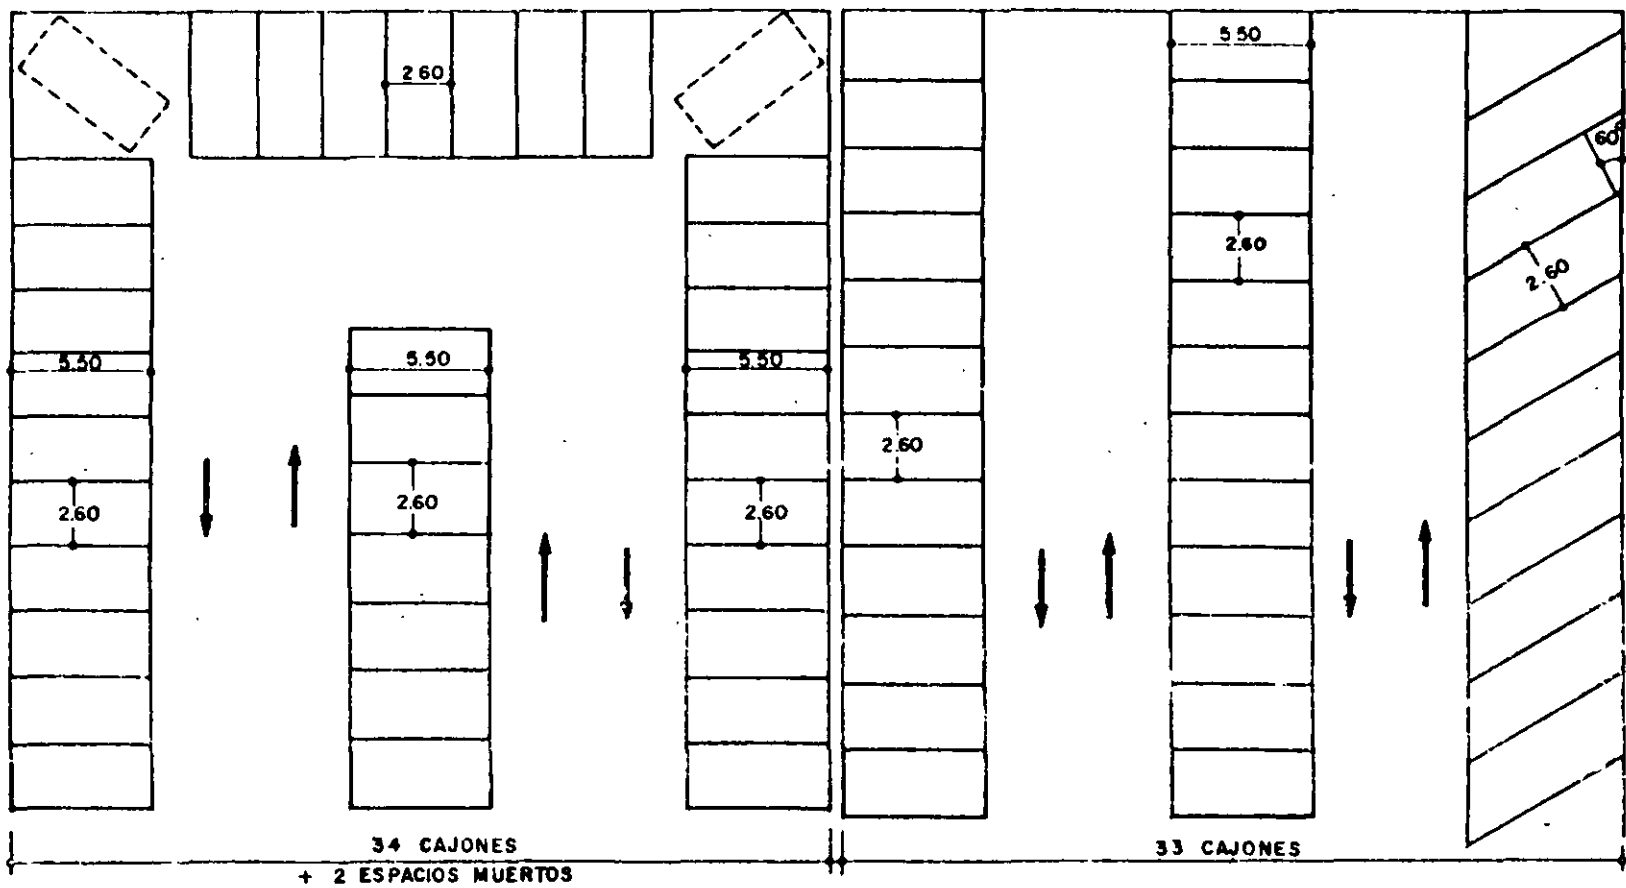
ALTERNATIVAS DE DISTRIBUCION PARA UN LOTE DETERMINADO
